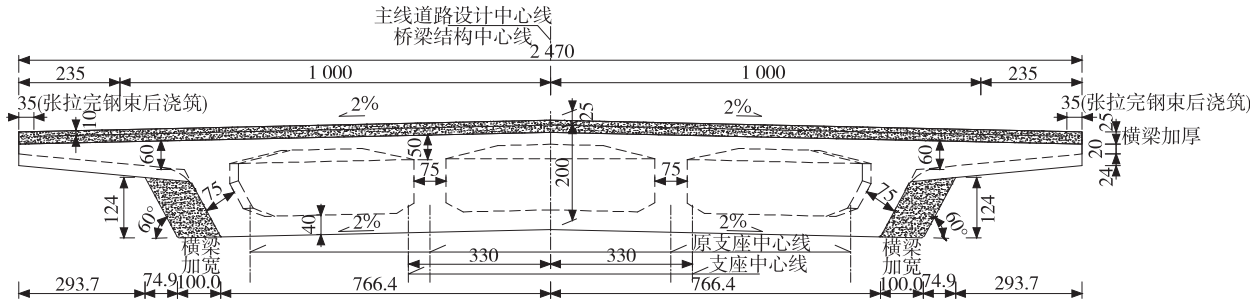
改造后 Pm123 横梁构造立面图(单位:cm)
